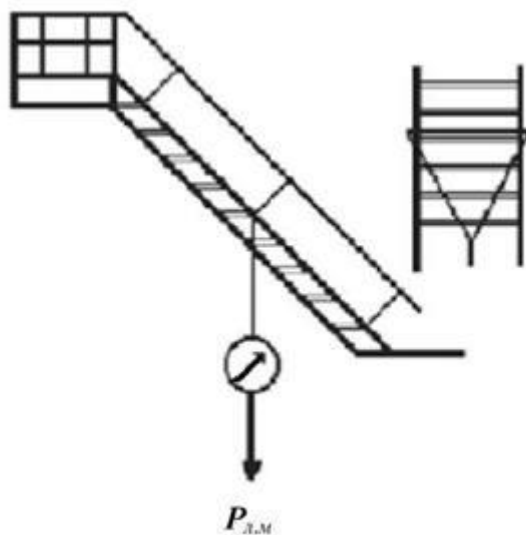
Схема приложения испытательной нагрузки для лестничного марша
